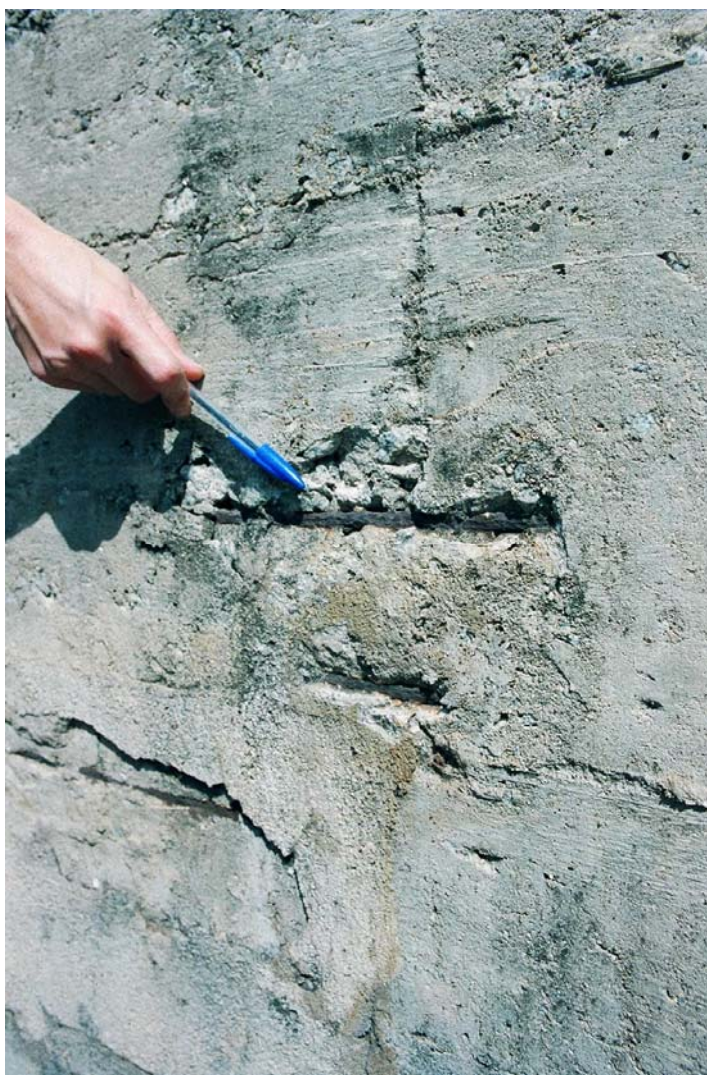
Corrosão já instalada no estribo e costela da viga da cobertura
